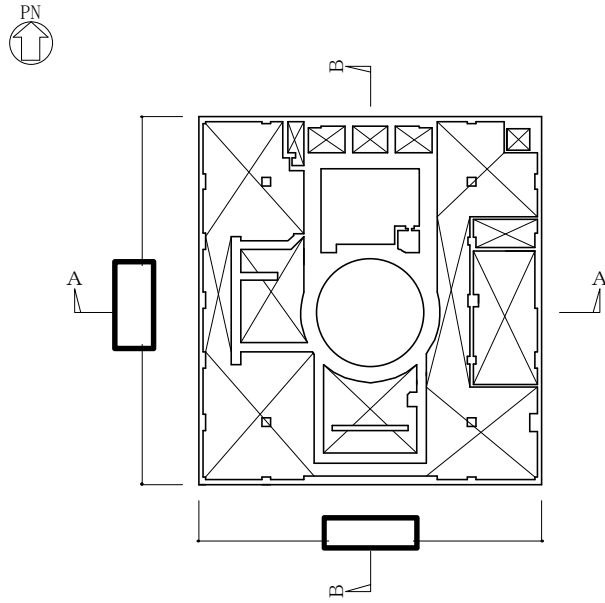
(7/10) 原子炉建屋の概略平面図 (EL. 34.7 m)
